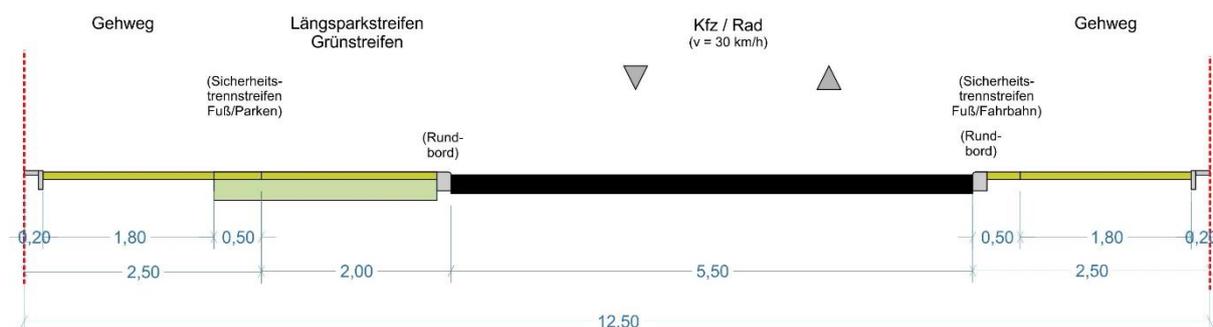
Regelquerschnitt Straßentyp S2 – Sammelstraße (Blick nach Nord)
